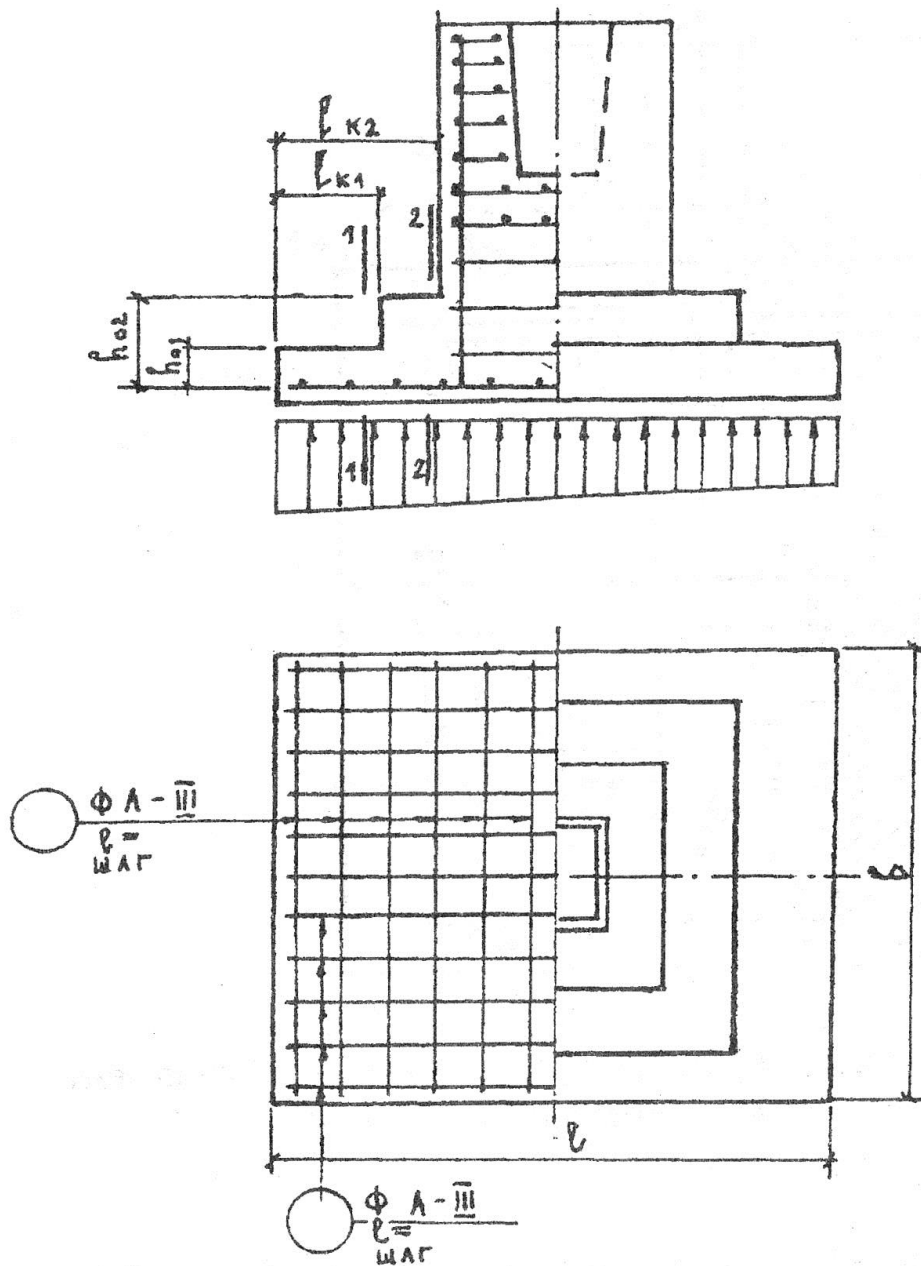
Схемы к расчету армирования плиты фундамента
